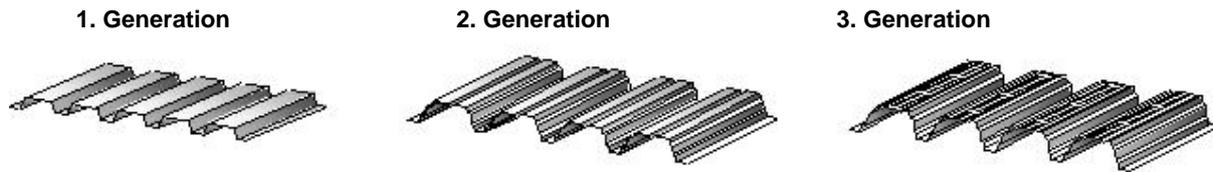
Stahltrapezprofile der verschiedenen Generationen
